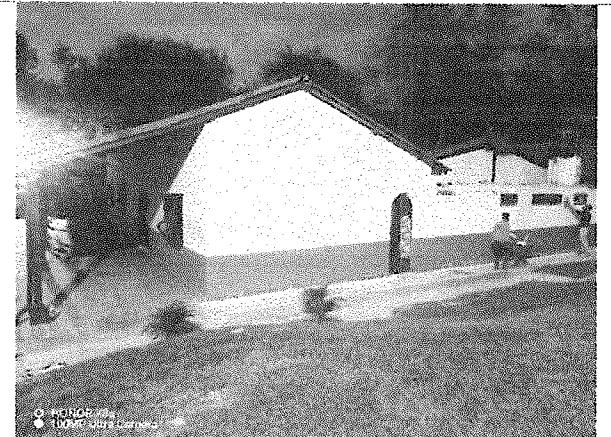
CASONA ASTURIAS (Pintura fachada)
